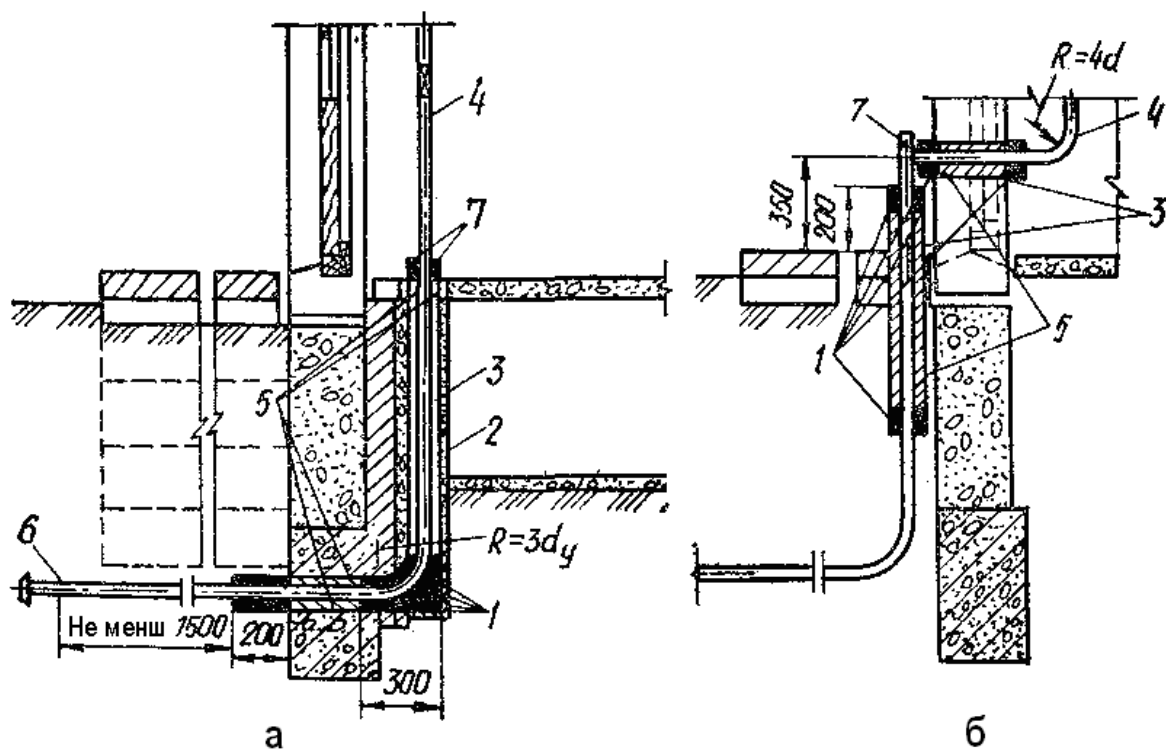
Увід газопроводу в будівлю: а – закритий; б – відкритий:
